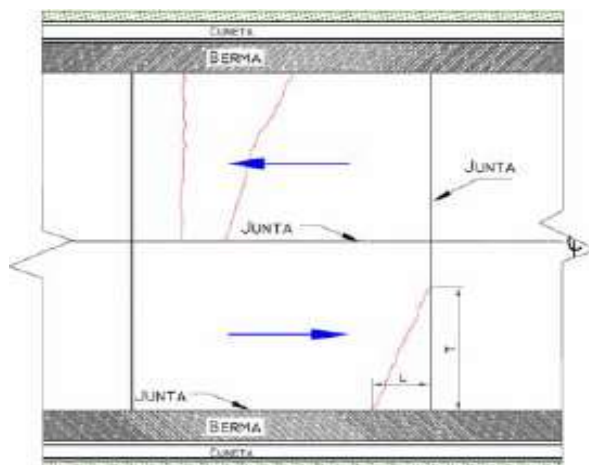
Vista en planta de grieta (GT) (INVIAS, 2006).
